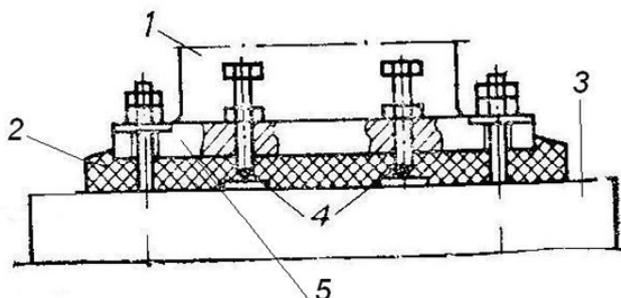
Схема установки оборудования на фундамент с опиранием на бетонную подушку:
